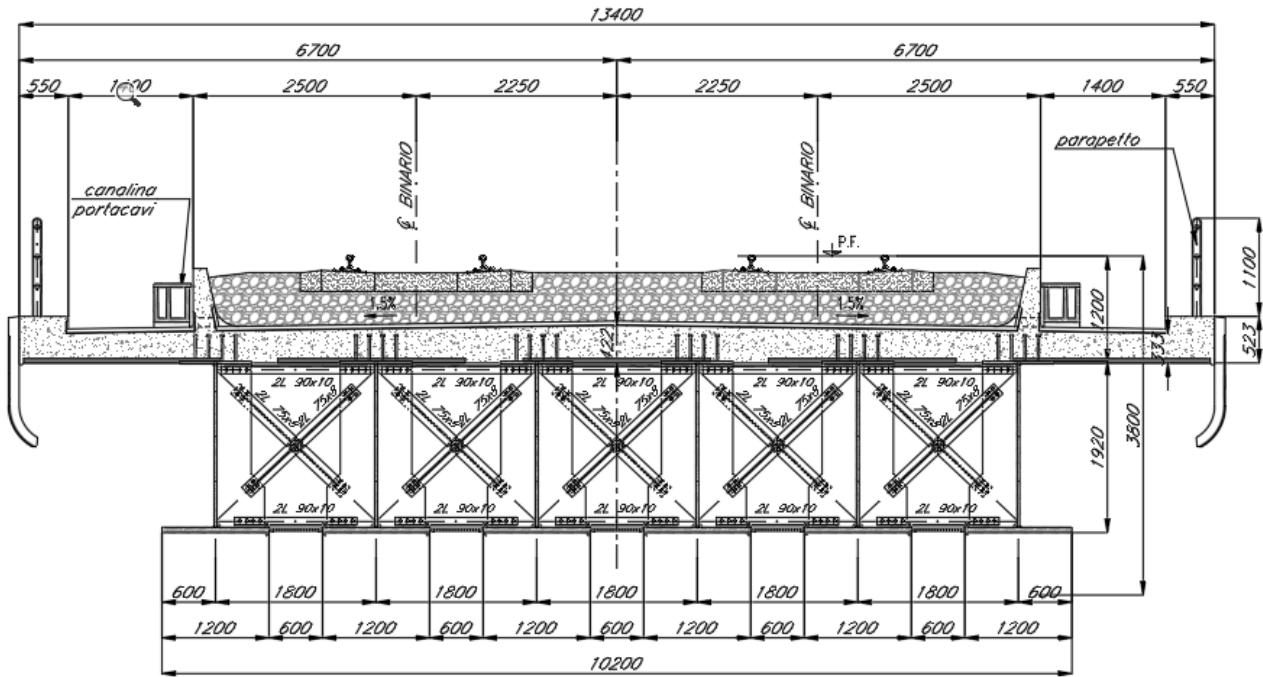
Sezione trasversale dell'impalcato misto a 6 travi
